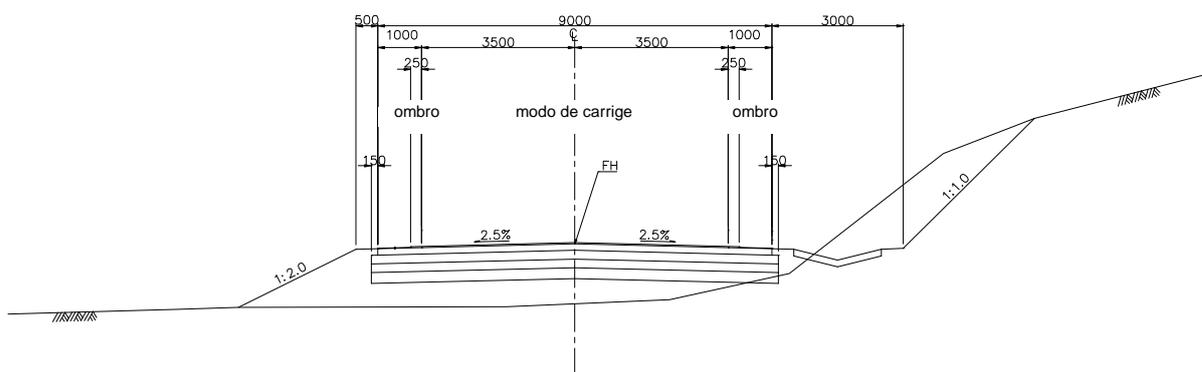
Perfil Transversal Típico Proposto (para Áreas Não Povoadas)
